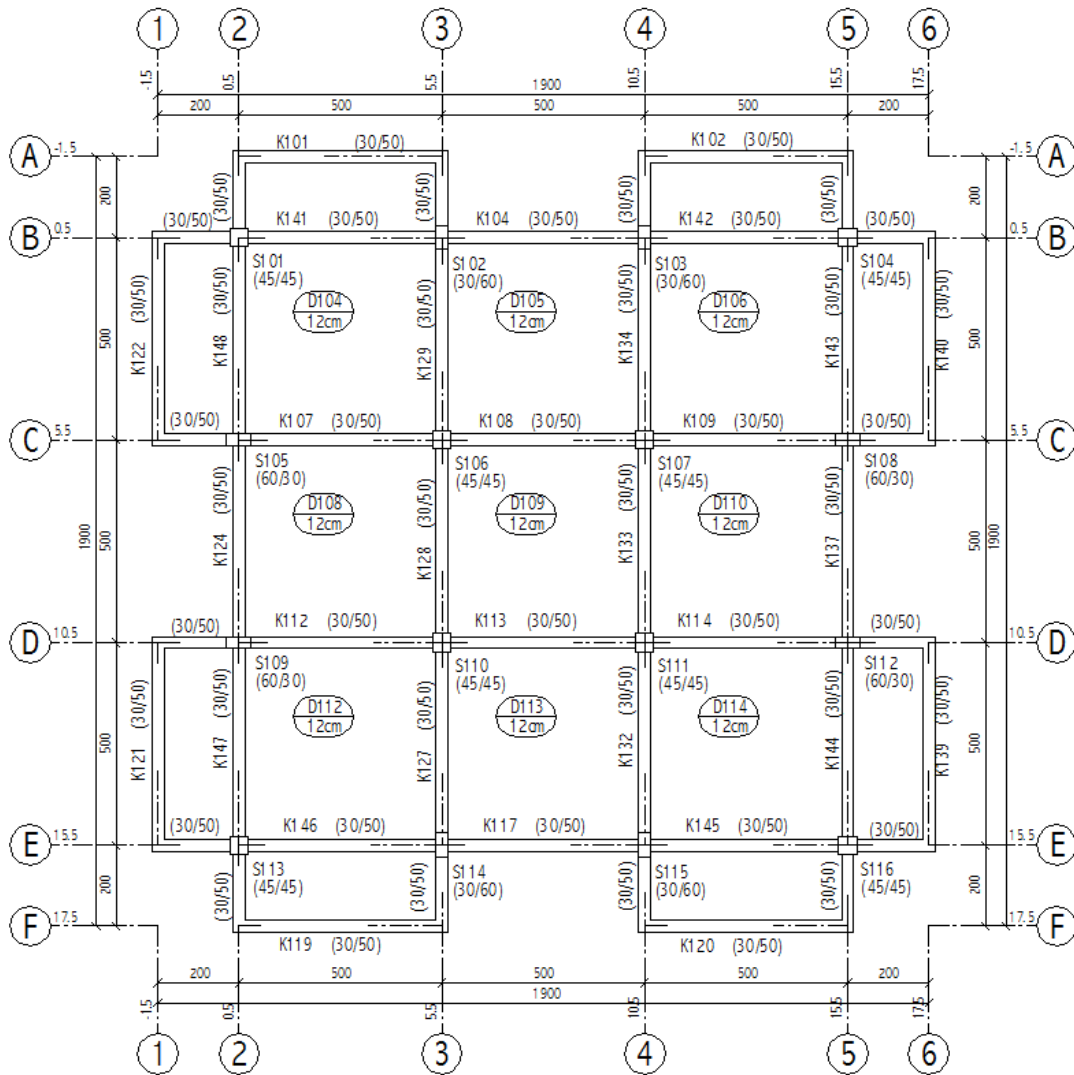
Bina A 5 katlı basık kirişli plan bilgisi
